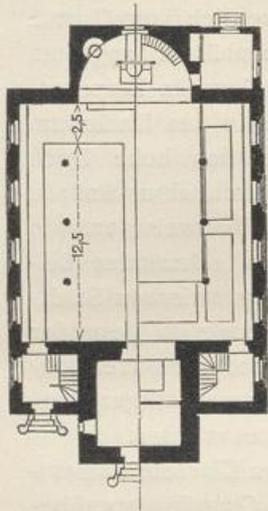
Grundrisse zu ebener Erde und in Emporenhöhe.
